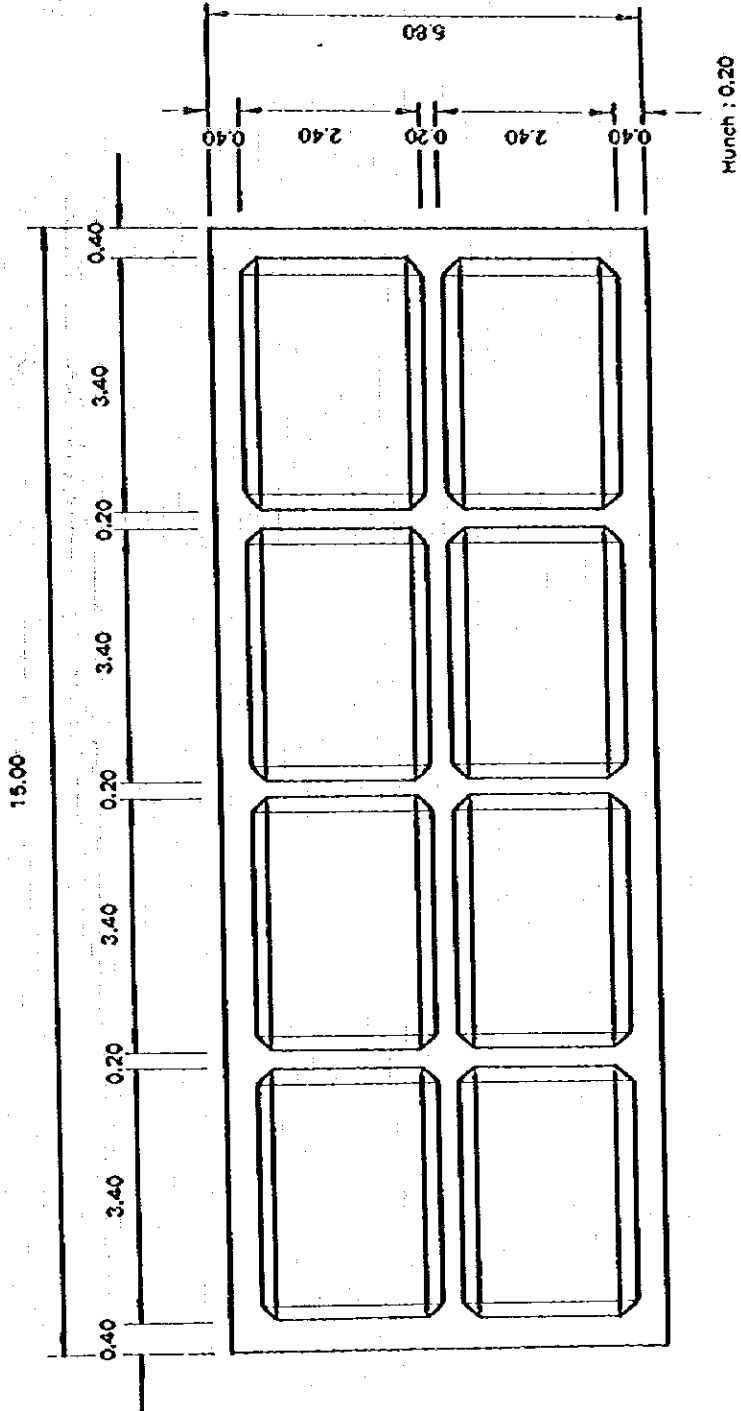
(a) 電力式ケーソン形橋断面図(—7.5m)
